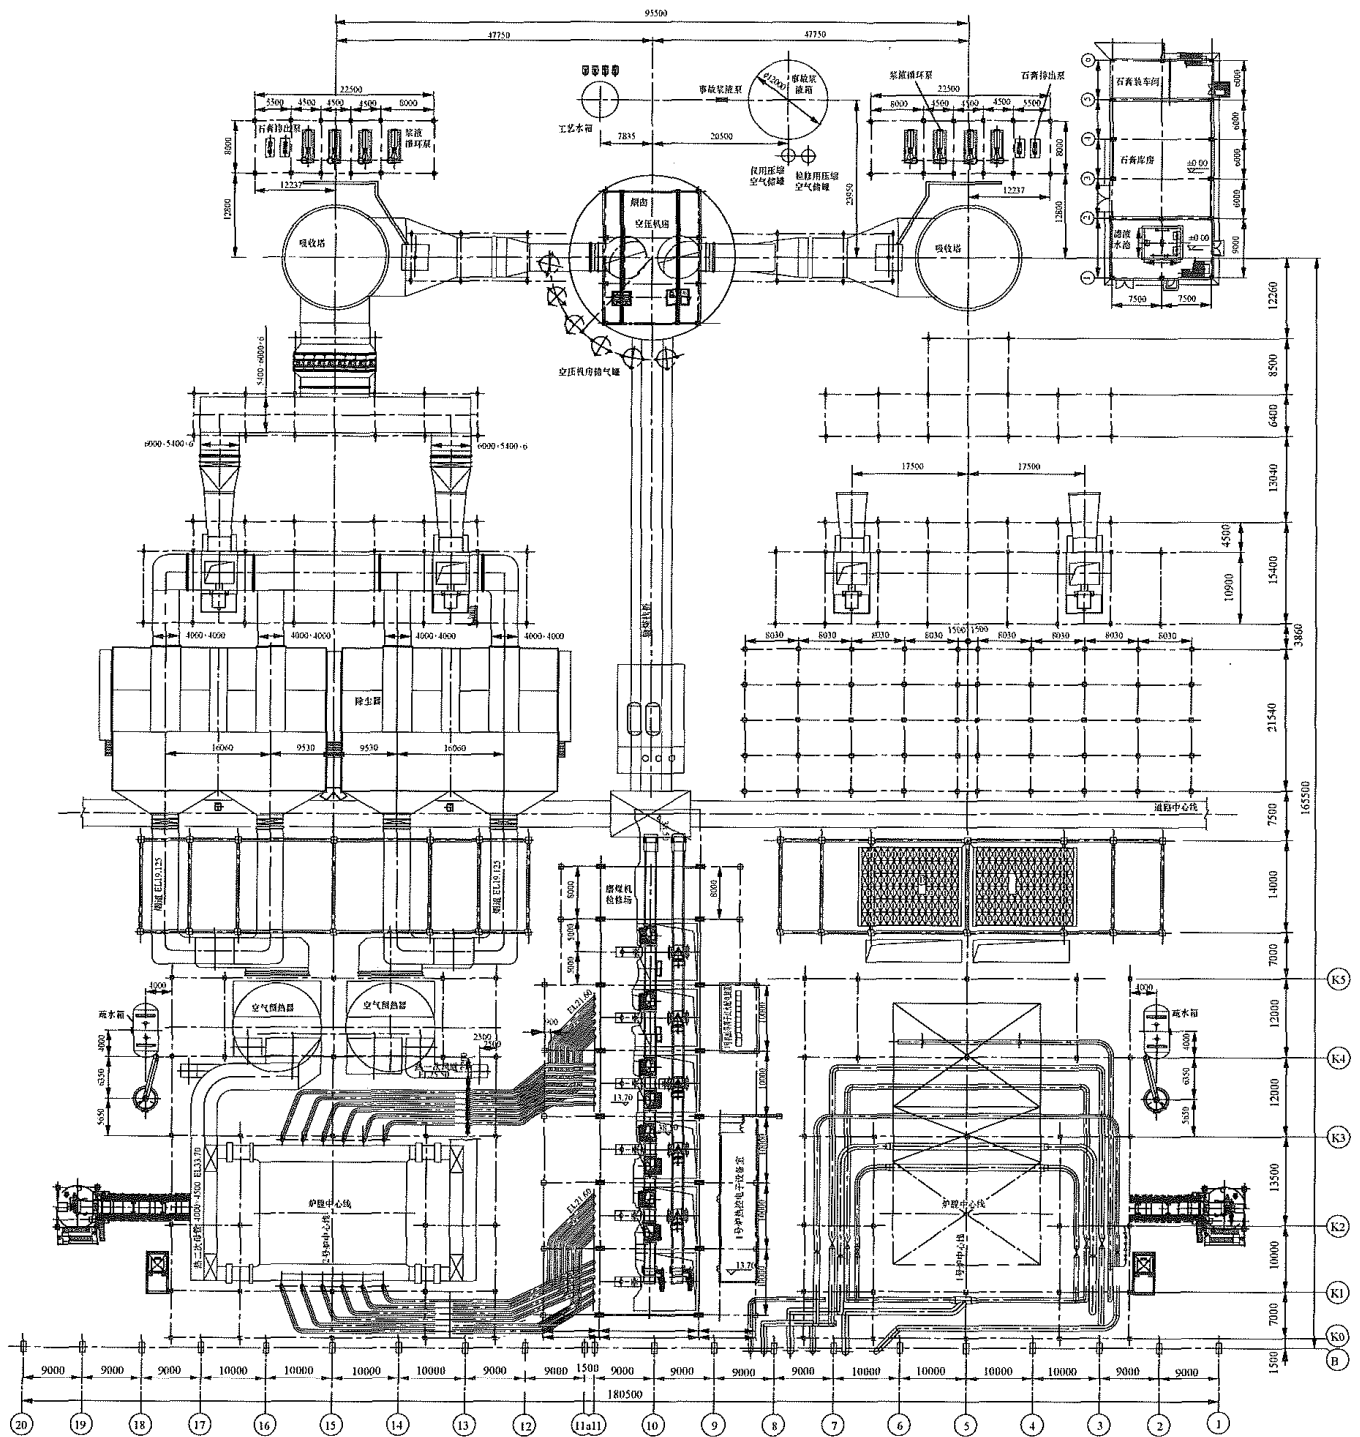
典型的 600MW 级机组侧煤仓锅炉岛主厂房平面布置示意图
